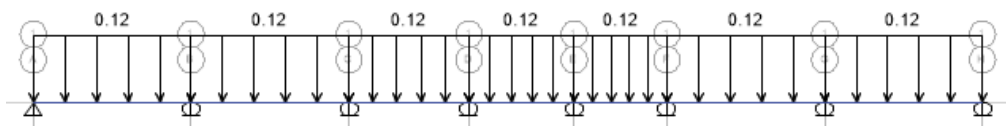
Carga muerta distribuida en vigueta de losa aligerada
